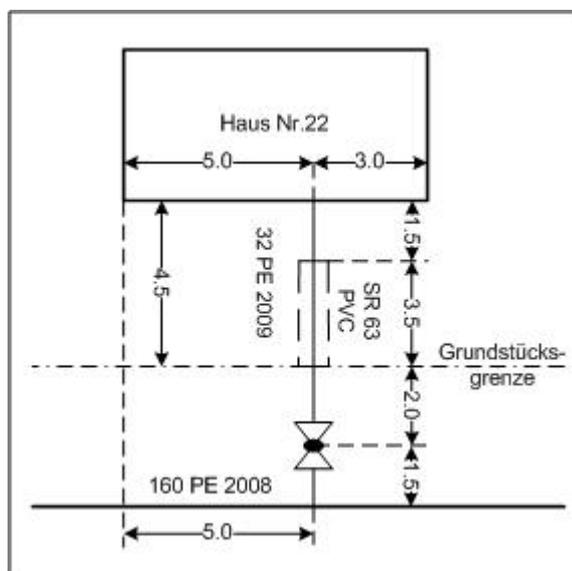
Fachgerechte Einmessung eines Hausanschlusses
